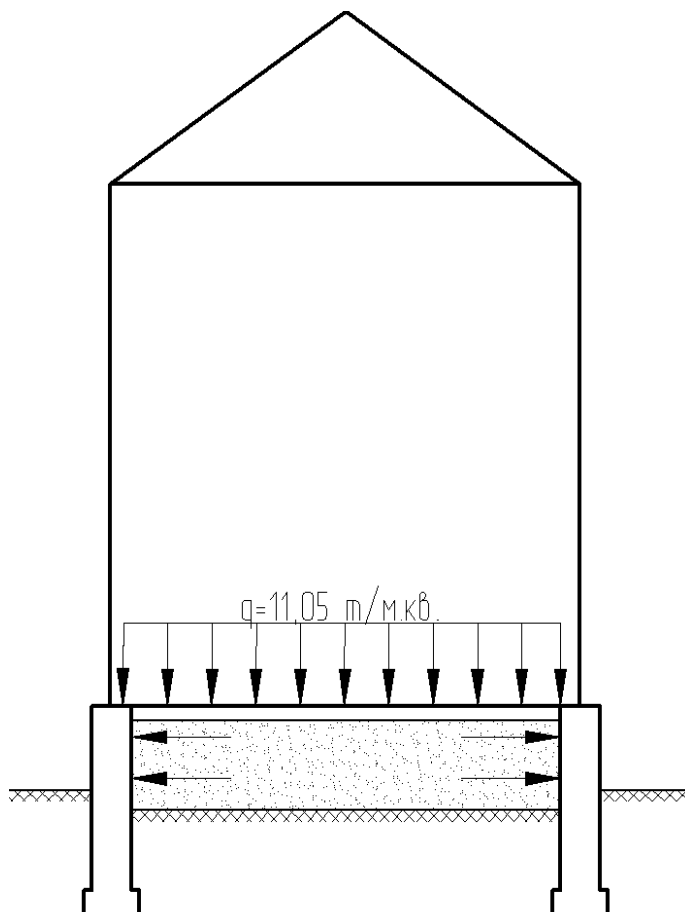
Схема навантаження на фундаментну конструкцію
